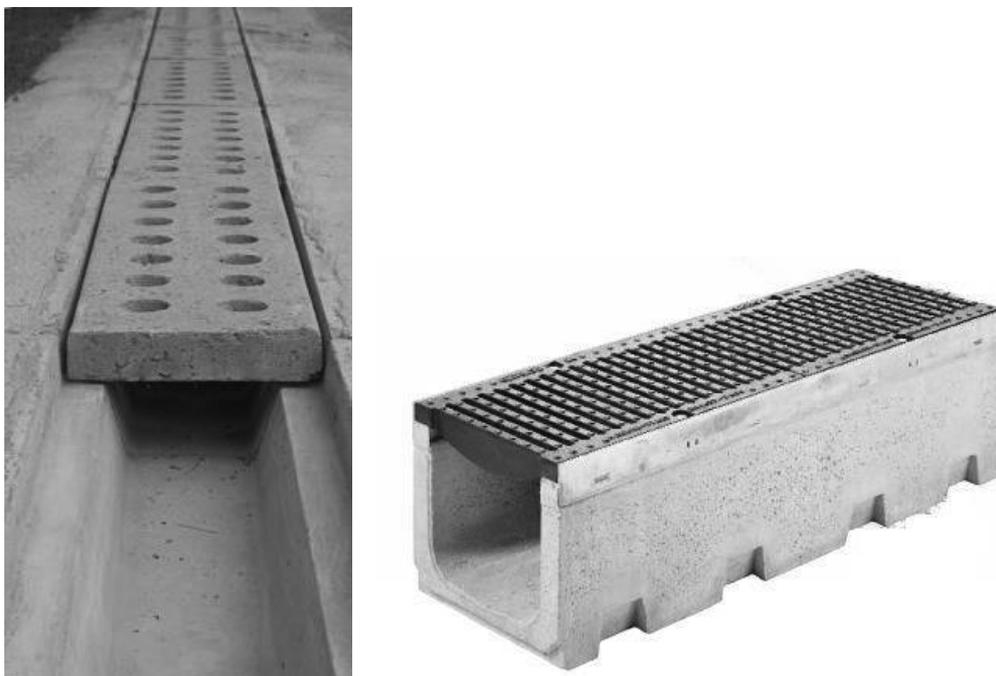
Caniveau béton avec grille métallique ou béton, lien entre descentes EP et noues
